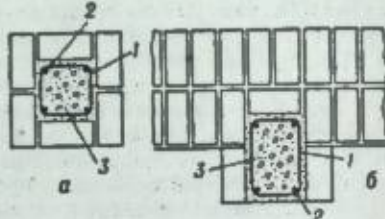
Усиление каменной кладки железобетоном (комплексные конструкции): а — с внутренним расположением железобетона; б — с расположением железобетона в открытом канале; 1 — хомуты; 2 — вертикальная арматура; 3 — бетон.
